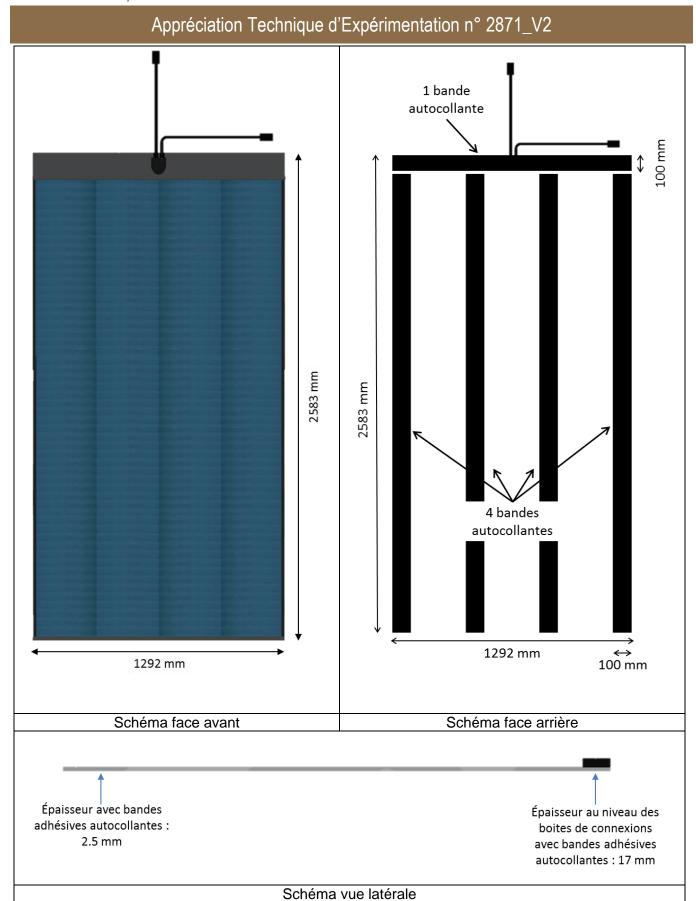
Dimensions du module photovoltaïque et positions des bandes de butyle autocollantes
